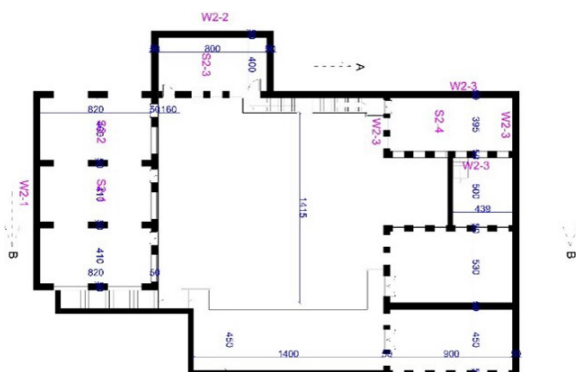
تحليل مسقط الطابق الأول لمدرسة الأم
